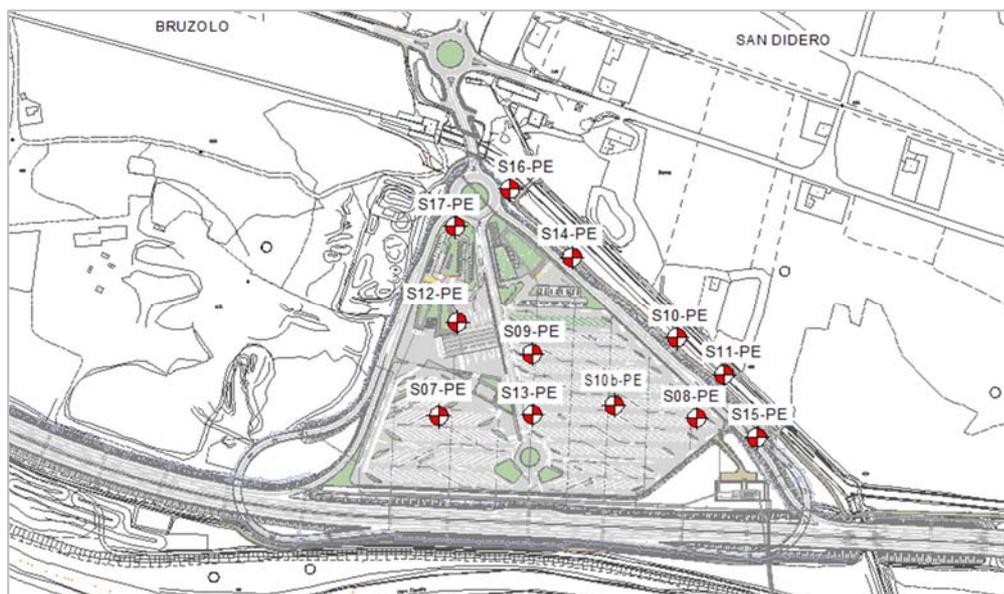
Planimetria di localizzazione delle indagini di PE con sovrapposizione progetto
